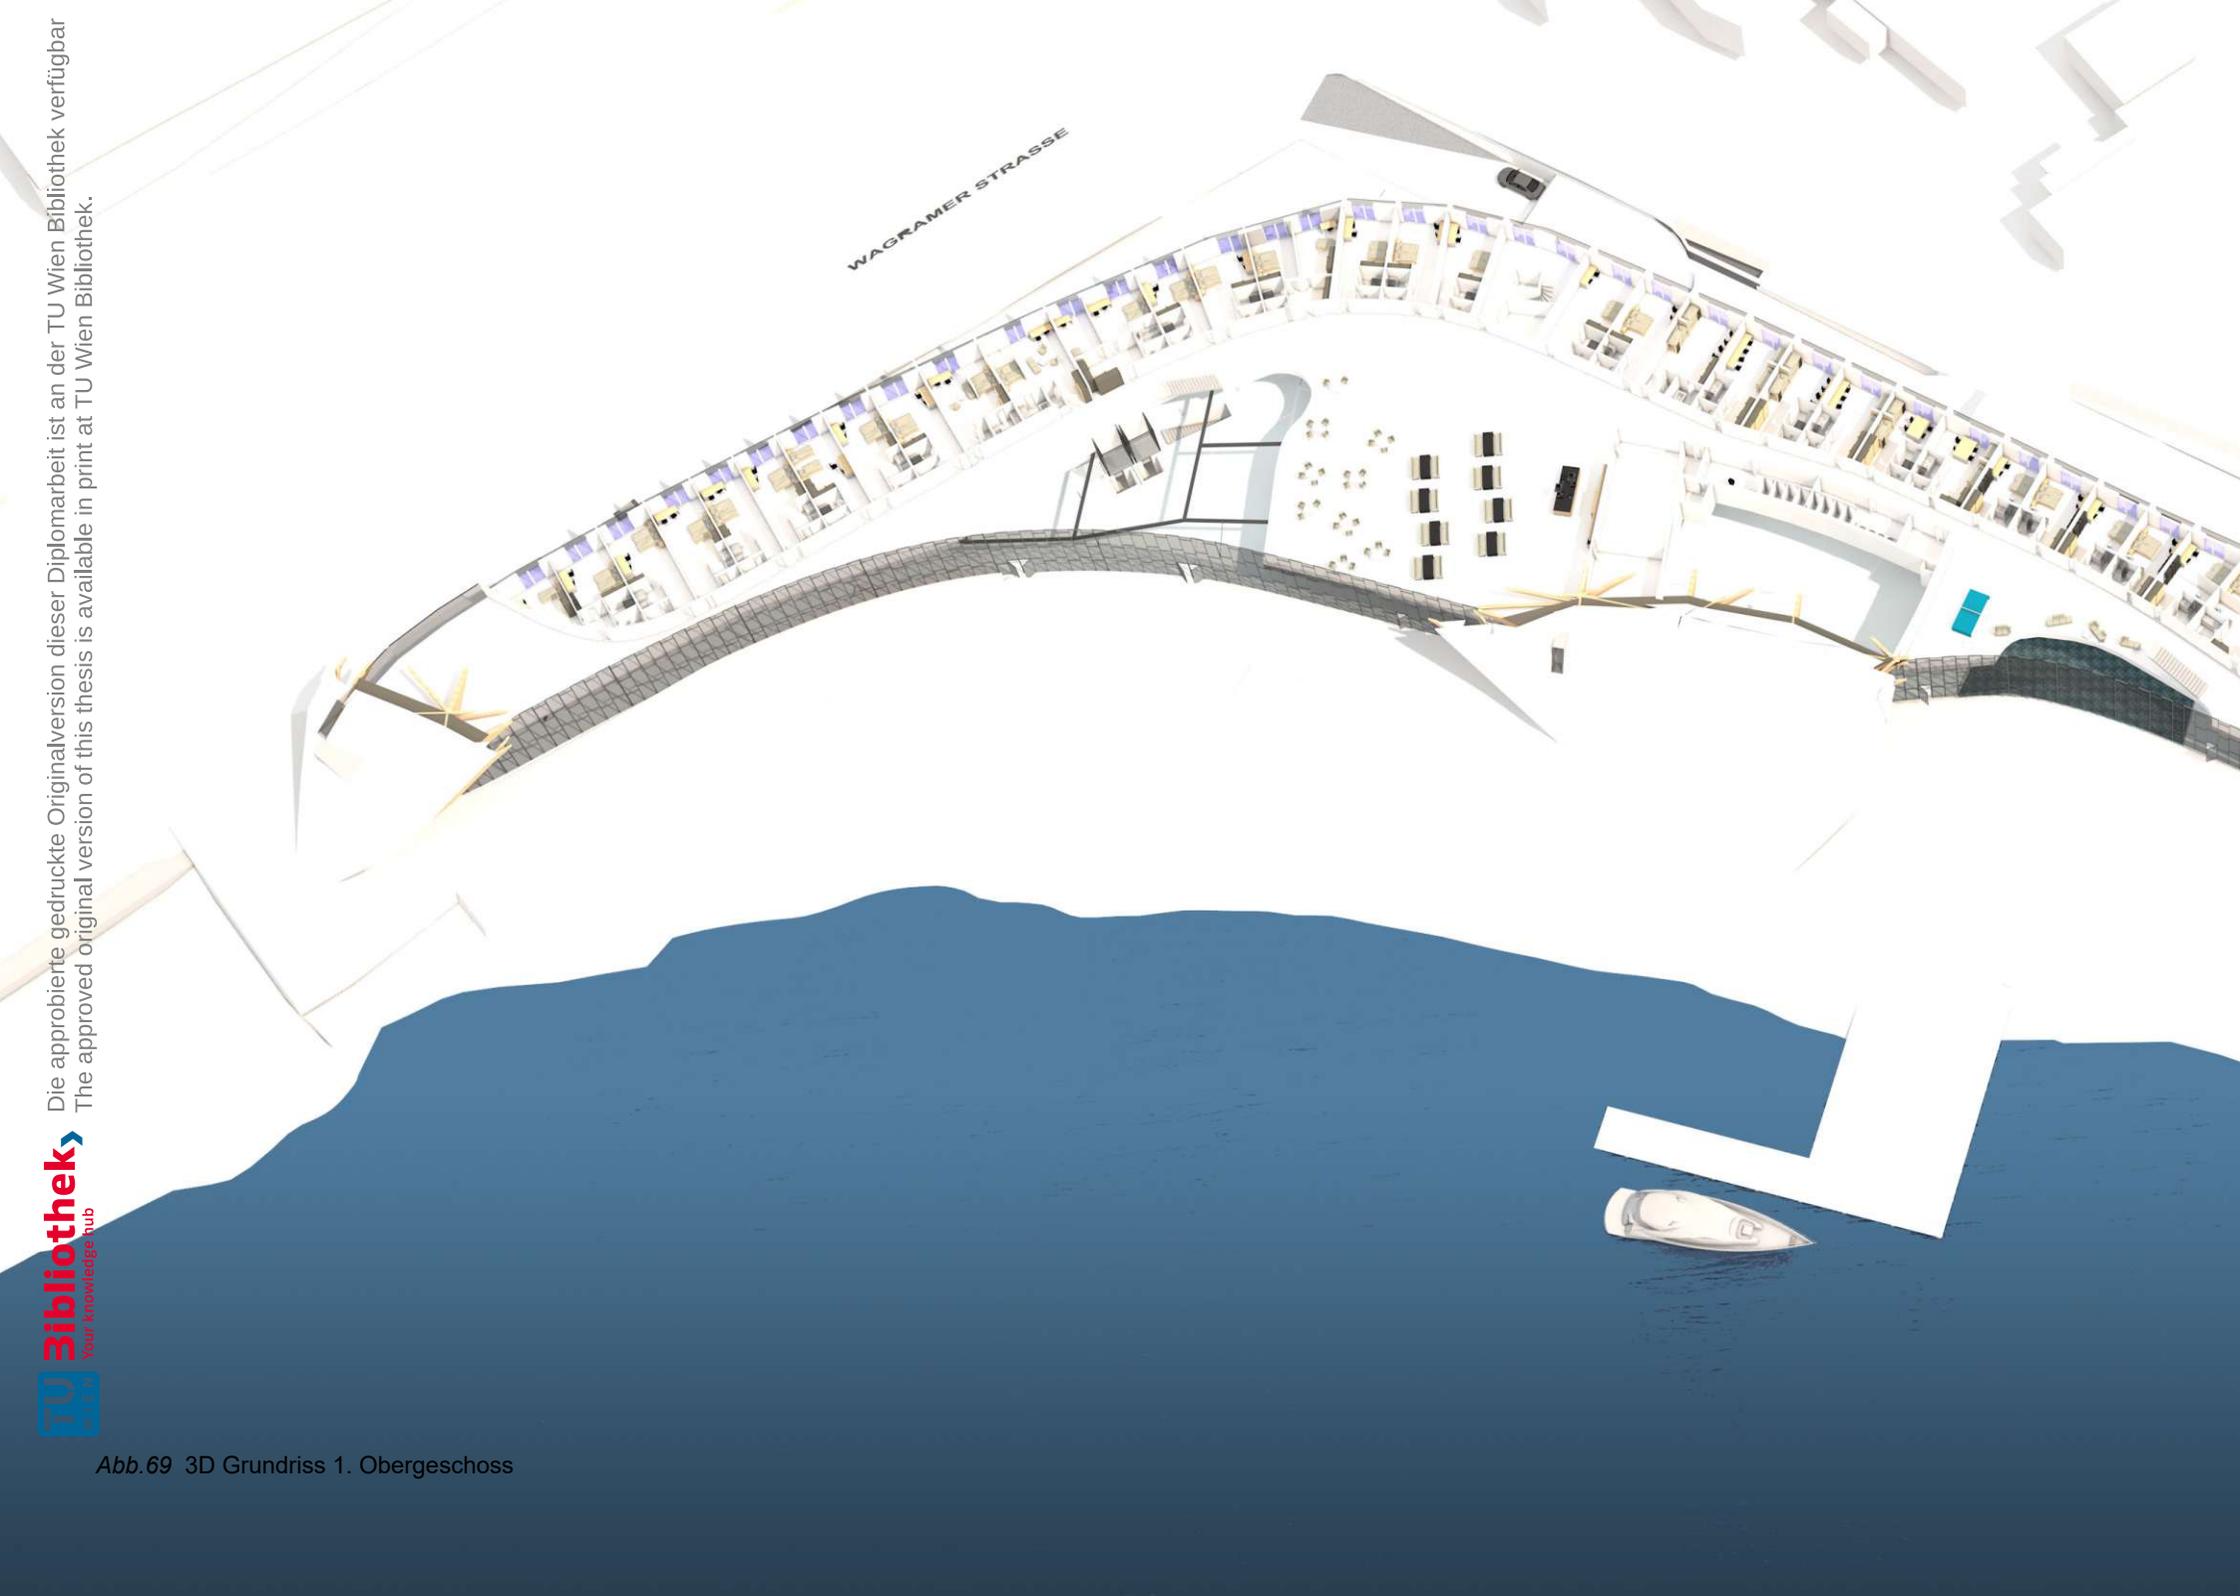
3D Grundriss 1. Obergeschoss
